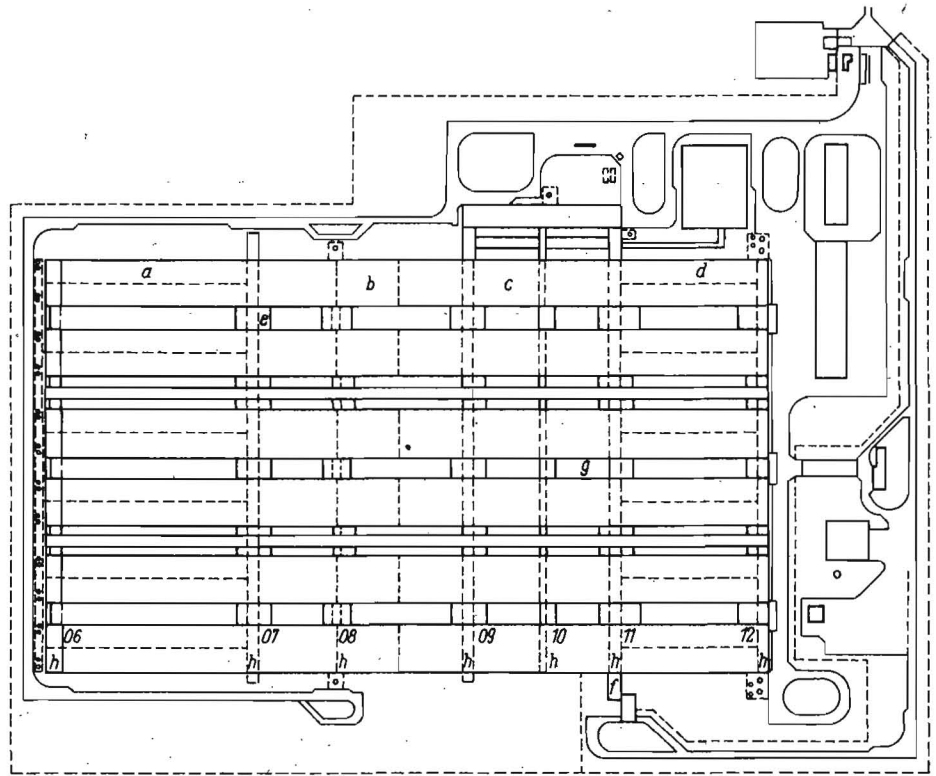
Lageplan einer Schweineproduktionsanlage S 111; a Jungsauenstall, b Besamungs- und Wartestall, c Abferkelstall, d Ferkelaufzuchtstall, e Reinigungstechnik, f mobile Ausrüstung, Ausstattungs-ausrüstung, g Gülleförderung, h Verbinder 06 bis 12
